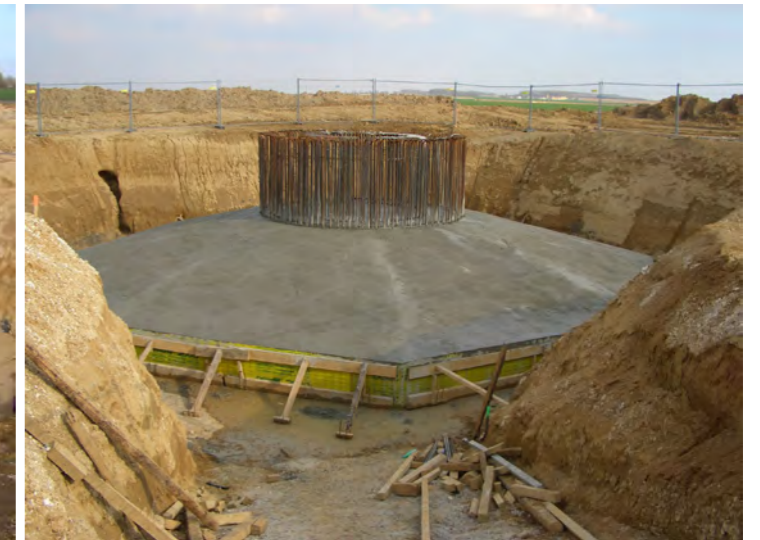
Excavation et terrassement pour l'installation des fondations
